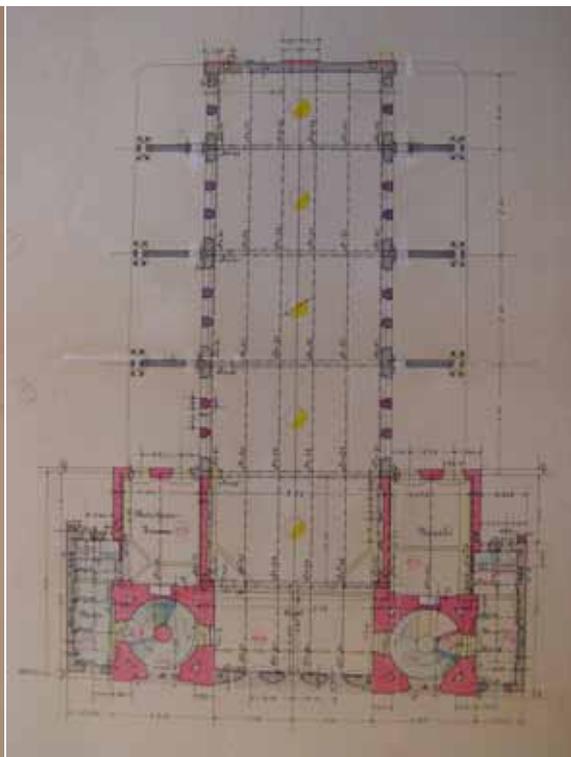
Grundriss in Höhe der Orgelbühne
